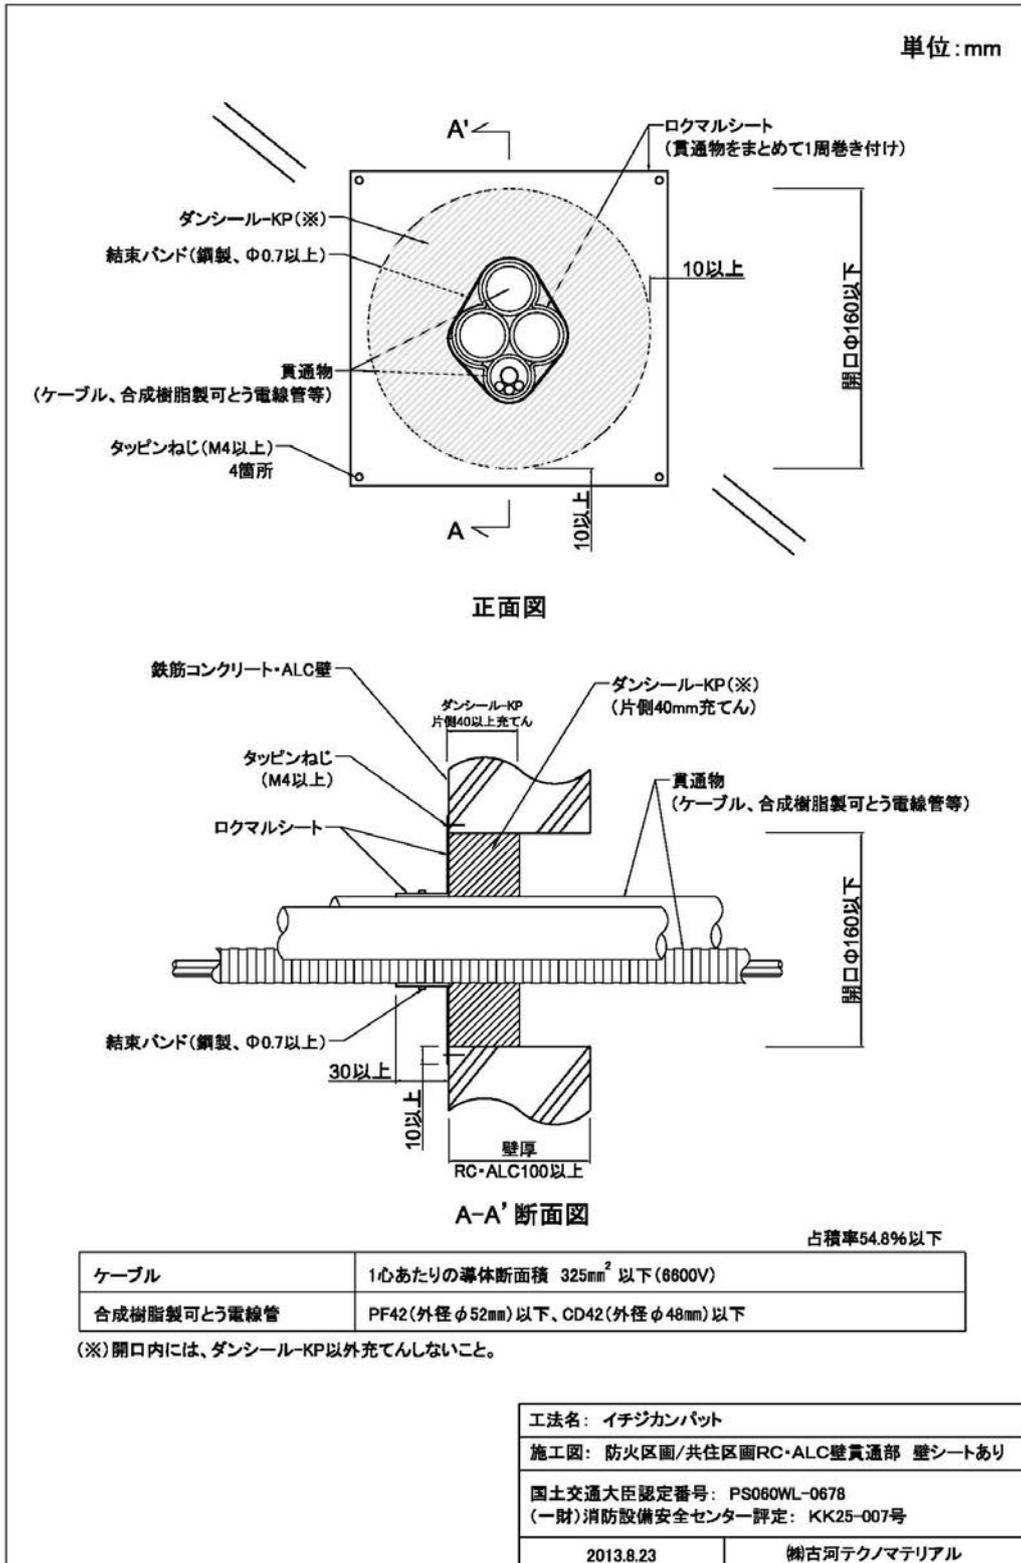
防火区画RC・ALC壁貫通部 壁シートあり標準施工図 および
